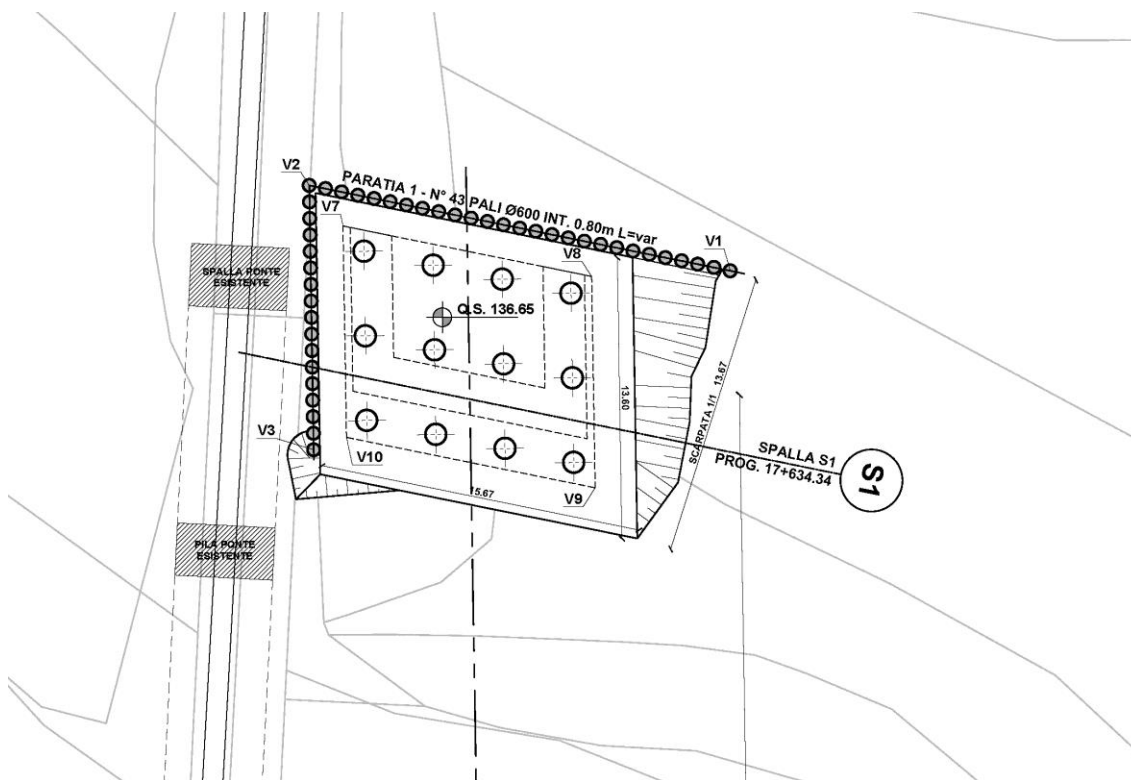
Pianta ubicazione paratie: pali C.F.A. 600mm, spalla S1.
